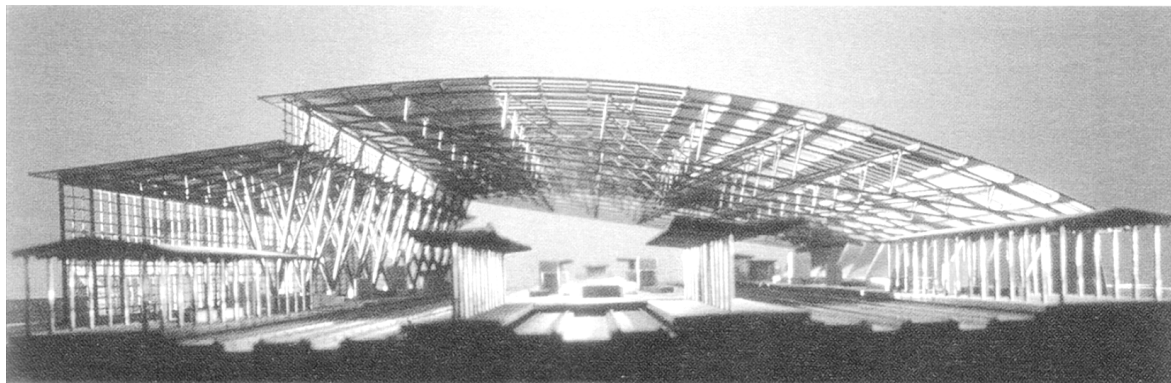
Modellfoto der neuen Erfurter Bahnhofshalle
